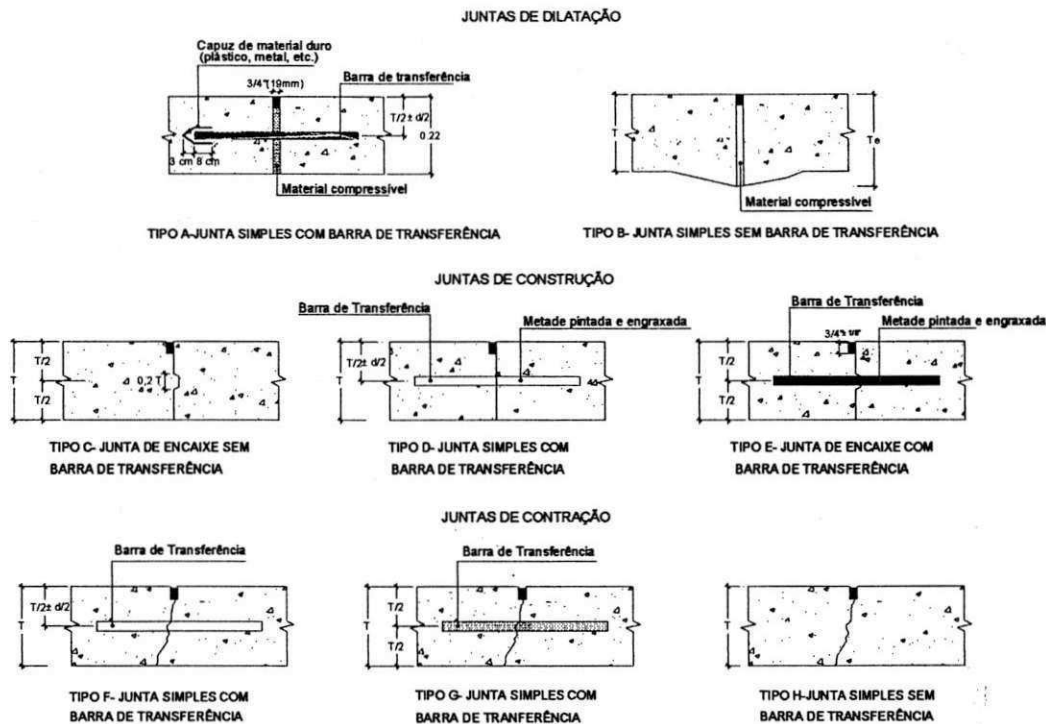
Tipos de juntas para pavimentos rígidos (FAA, 1995)
